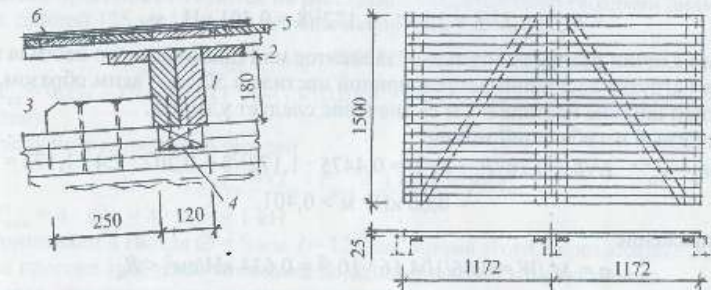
Дощато-гвоздевой щит покрытия и узел опирания прогона: 1 – прогон из двух досок на ребро; 2 – щит покрытия; 3 – бобышка, воспринимающая скатную составляющую нагрузки; 4 – бобышка, обеспечивающая устойчивость верхнего пояса фермы из плоскости; 5 – защитный косой настил кровли; 6 – трехслойный рубероидный ковер
